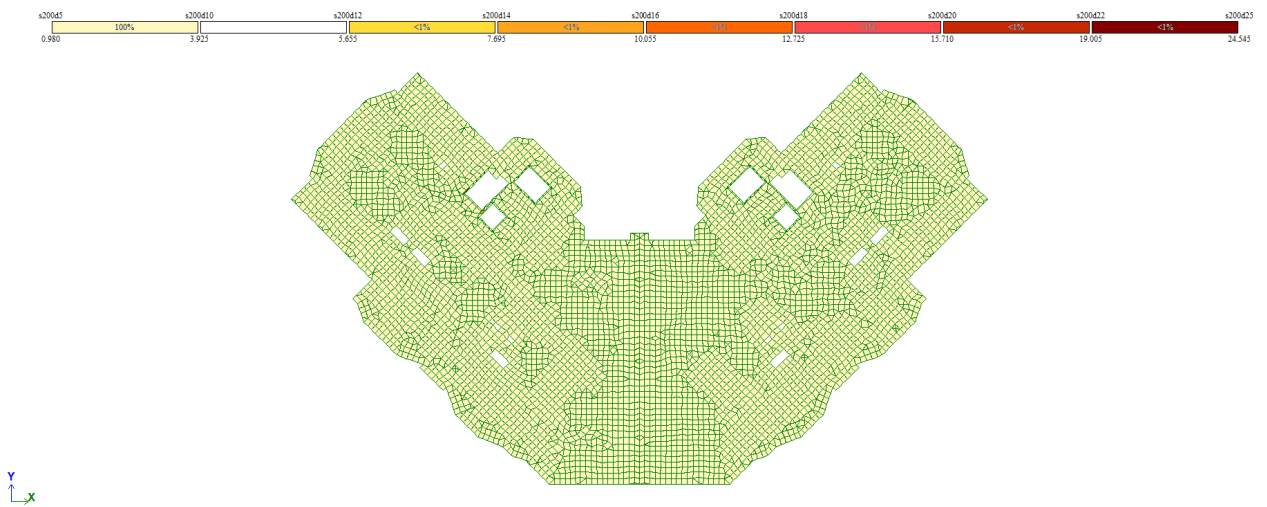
Площа арматури плити на 1 м. п. по осі x (нижня грань)
